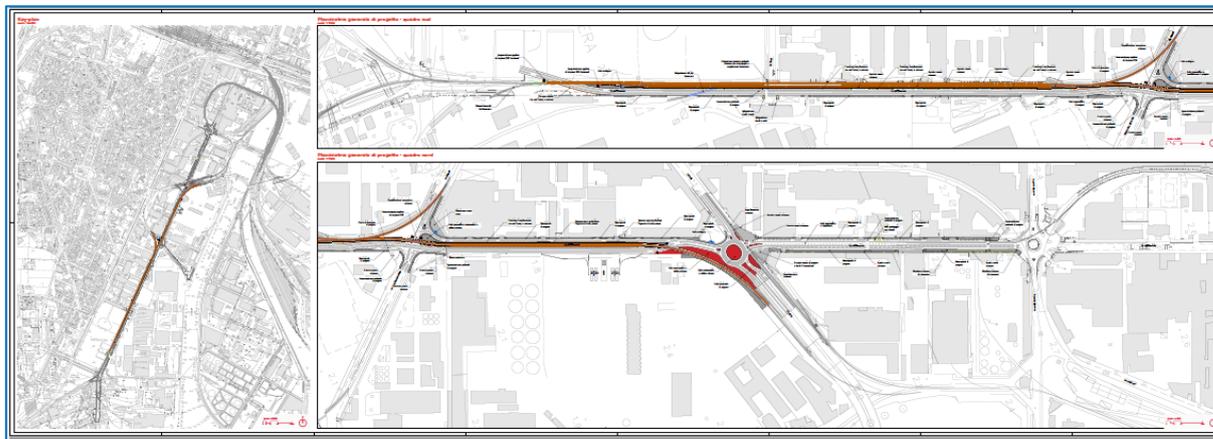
Planimetria dell'intervento - fonte AdspMAS
